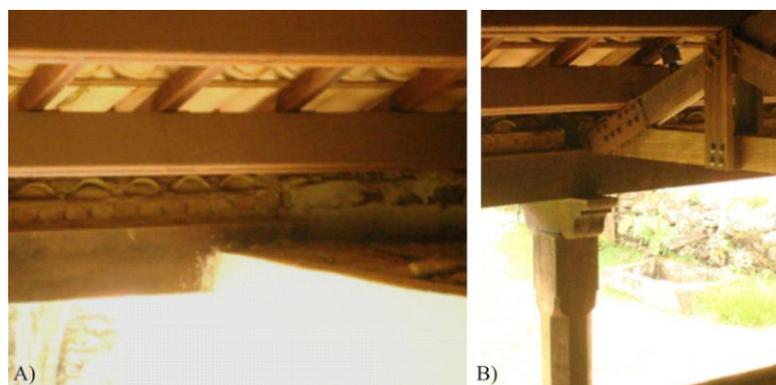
A) encontro do cintamento de concreto com o preenchimento de tijolos acima da viga de madeira. B) detalhe da mesma viga acima do pilar de madeira.
